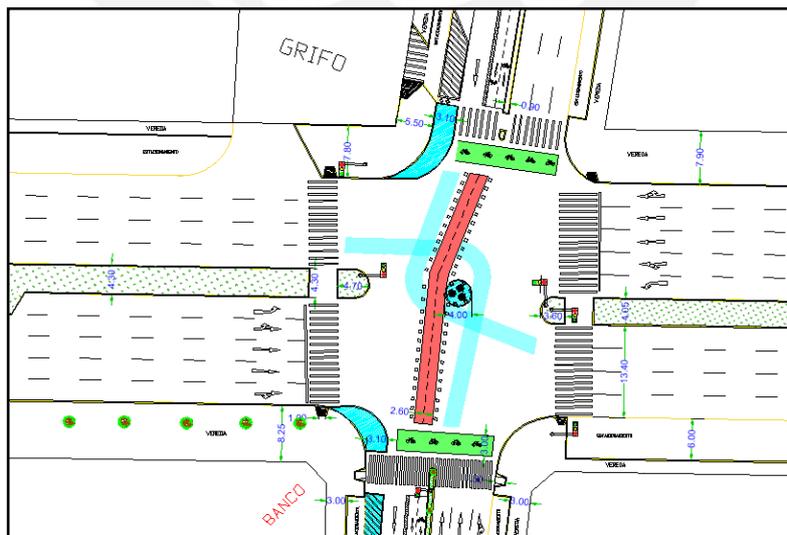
Vista en planta de situación propuesta del cruce Av. México con la Av. Parinacochas
